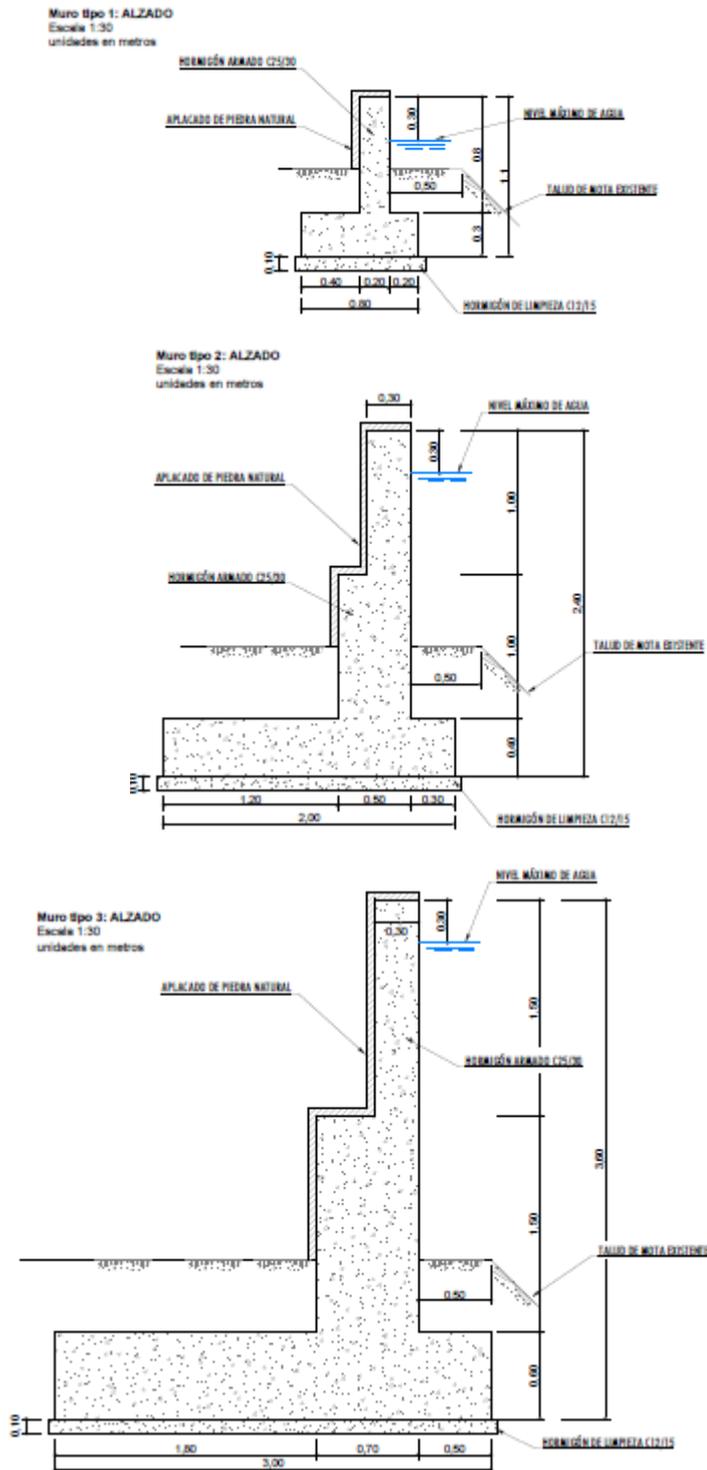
Muros de protección aguas abajo del puente de la AL-7107. Secciones tipo
